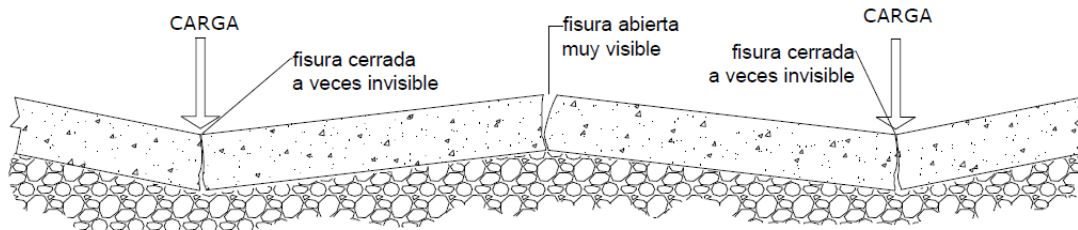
Esquema y ejemplos de fisuras estructurales.
